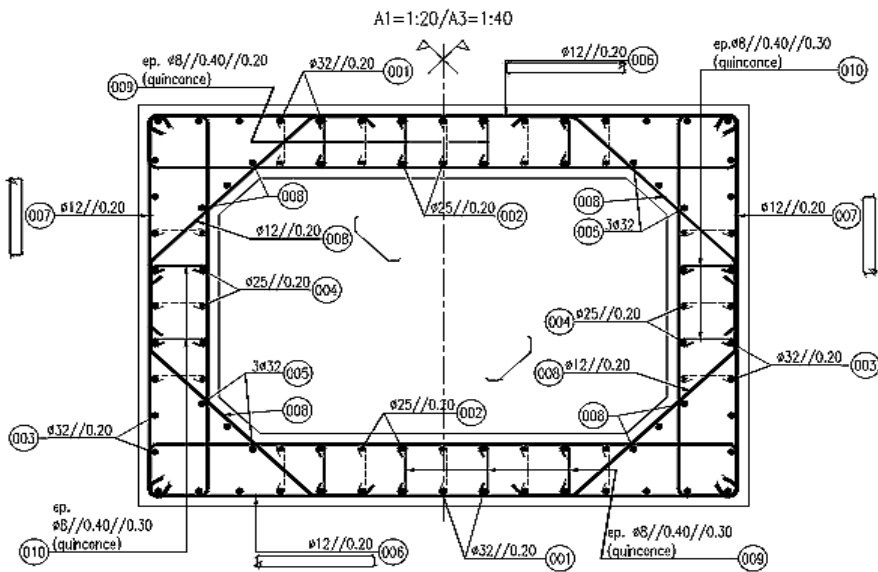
Le ferrailage longitudinal et transversal au milieu de fût des piles élancées
